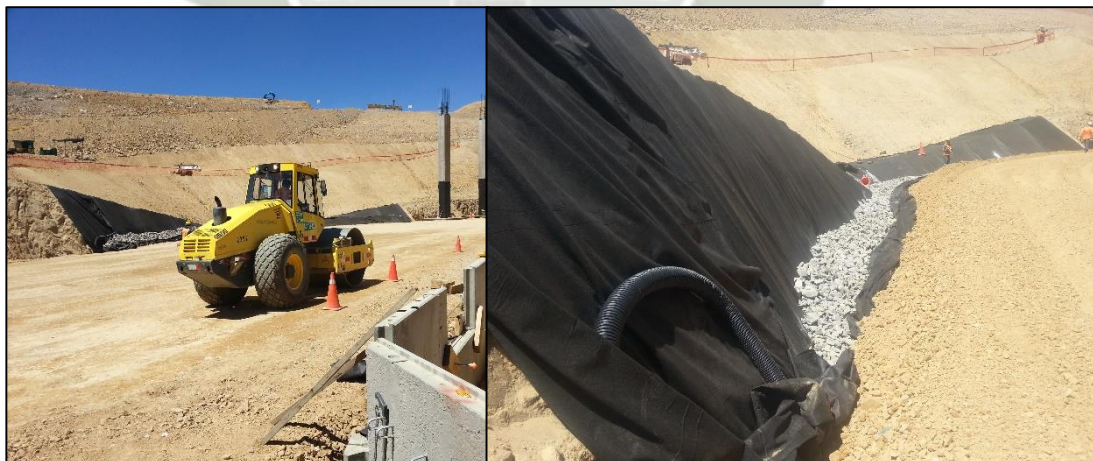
Terreno perfilado y drenaje posterior de acuerdo a los planos de construcción
